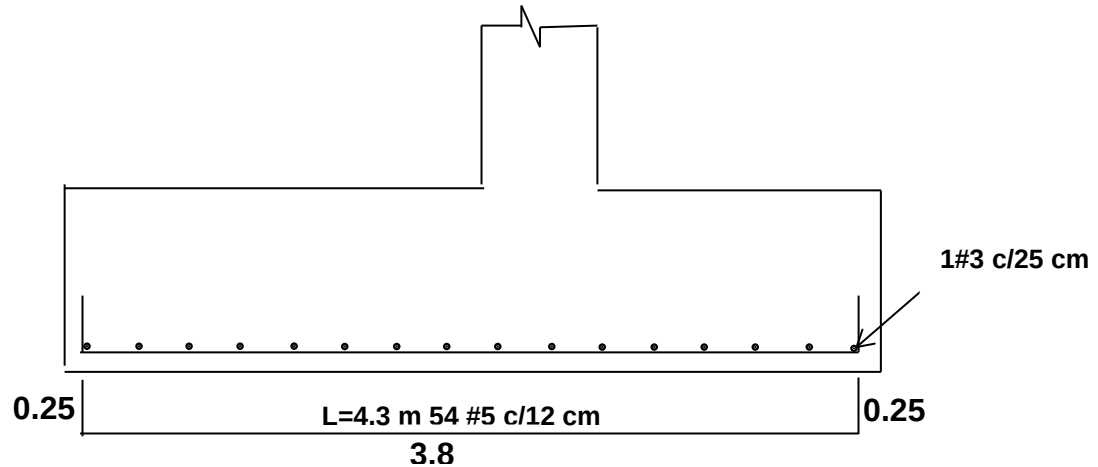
Detalle de armado de la zapata que corresponde a los esfuerzos producidos en la punta de ésta.
